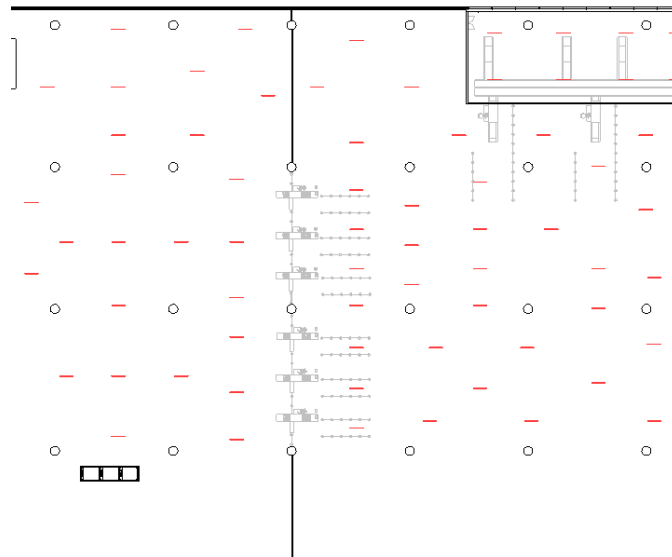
Detalle de la distribución de las luminarias de la planta baja.
